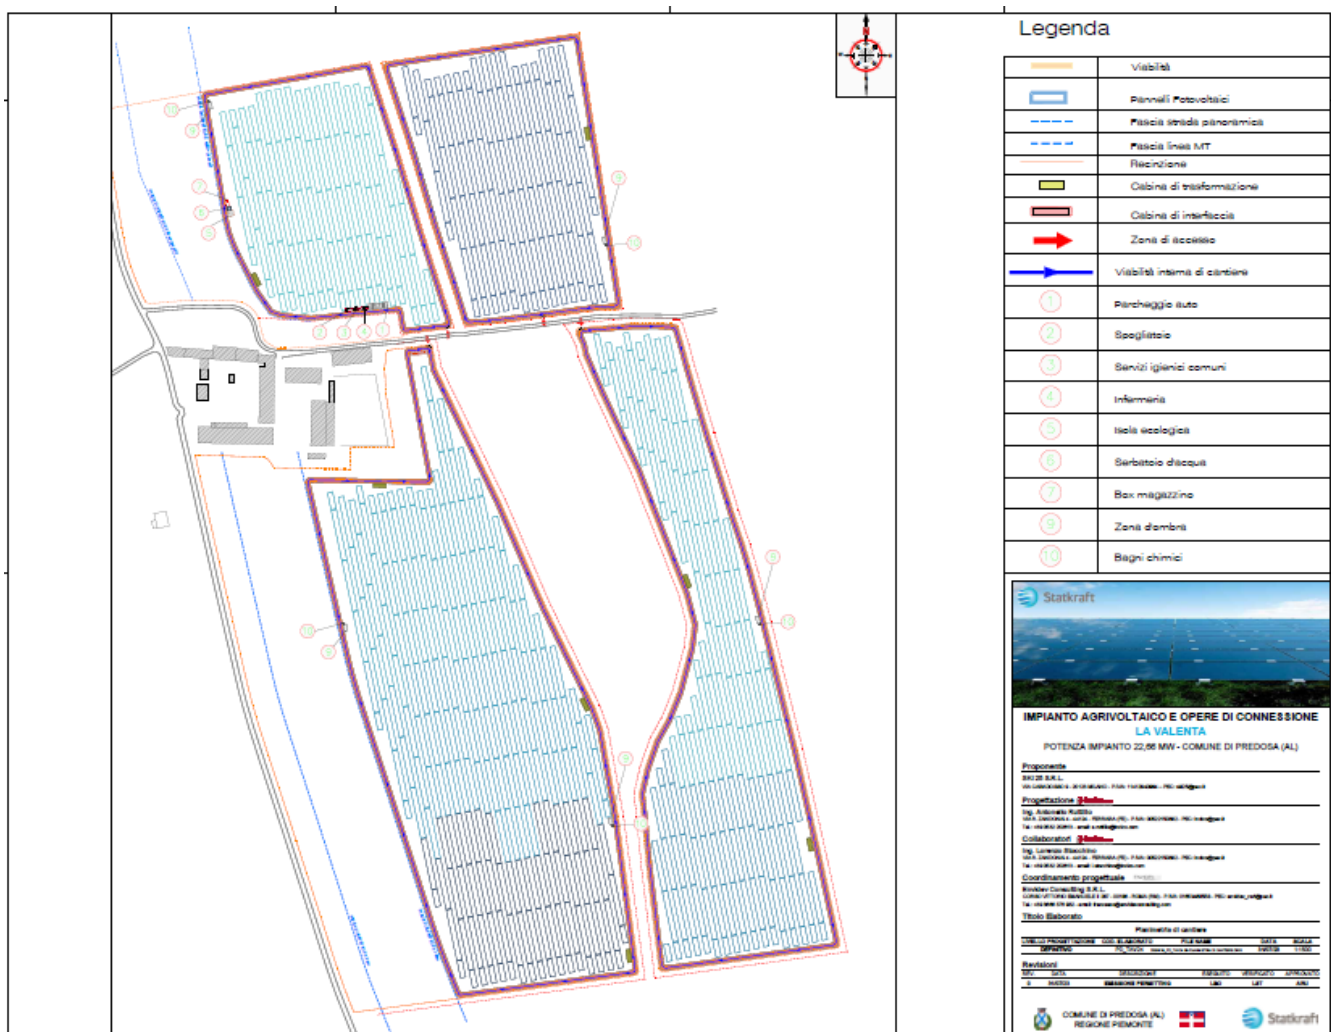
Estratto Tavola "Planimetria di cantiere (PD\_TAV24)
